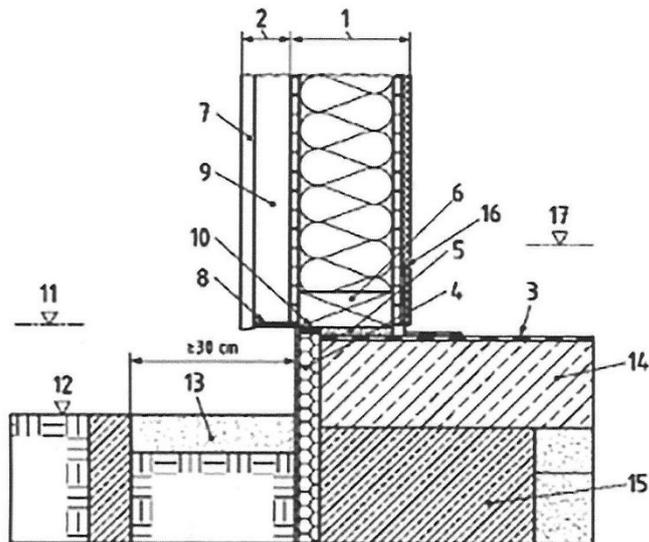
Punto più basso della parete esterna sporgente dalla fondazione con facciata ventilata
